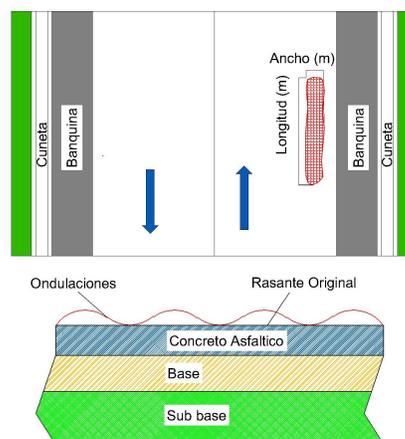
Ondulación (OND, unidad de medida: Hm)
